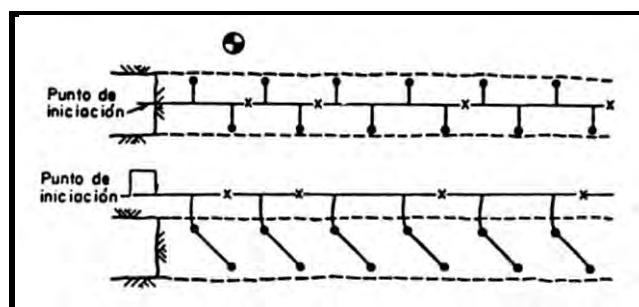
Arreglos de voladuras para la excavación de zanjas.
